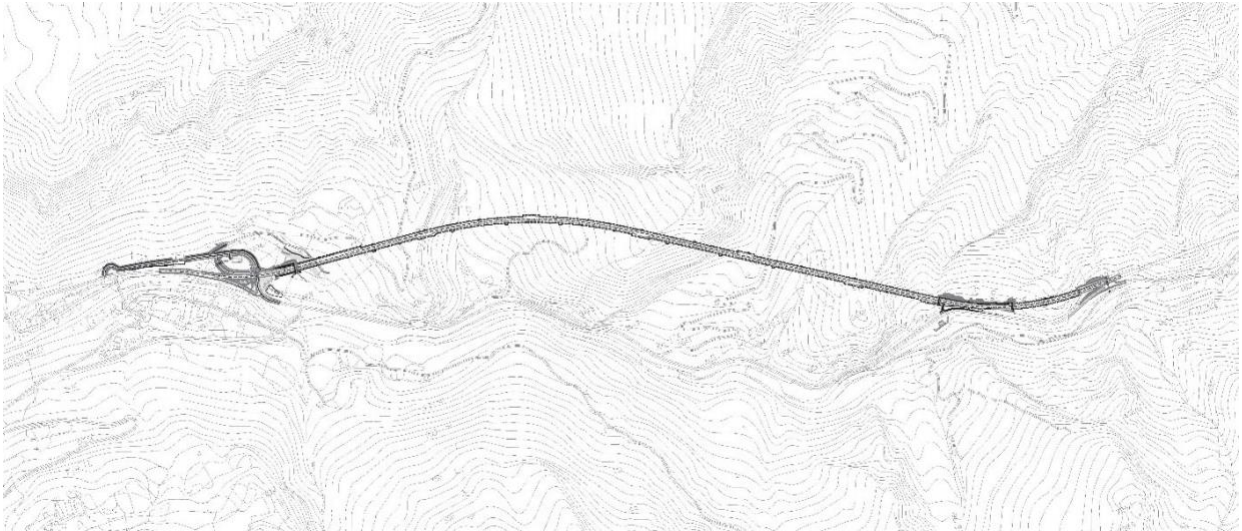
AN 256 – SS4 Salaria – Tratto Trisungo – Acquasanta Terme 1°Lotto 2° Stralcio dal km 151+000 al km 153+780
